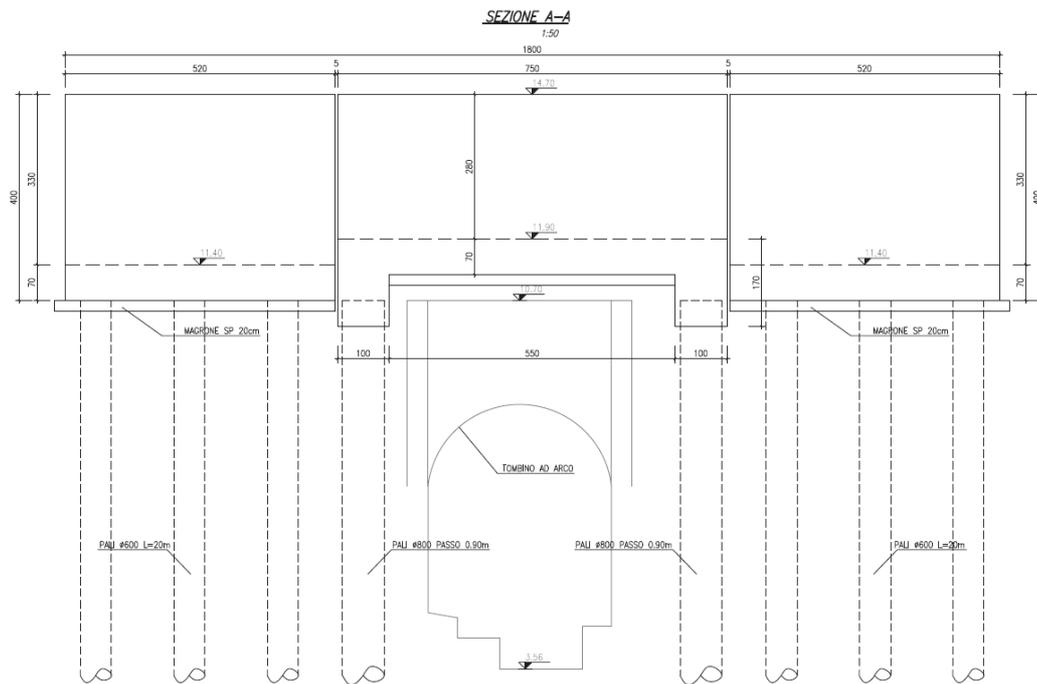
Solettone e muro su pali - sezione longitudinale
